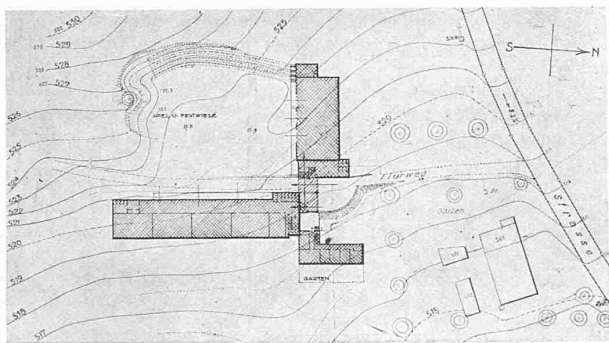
Lageplan 1 : 2000, mit 1 m-Höhenkurven.
